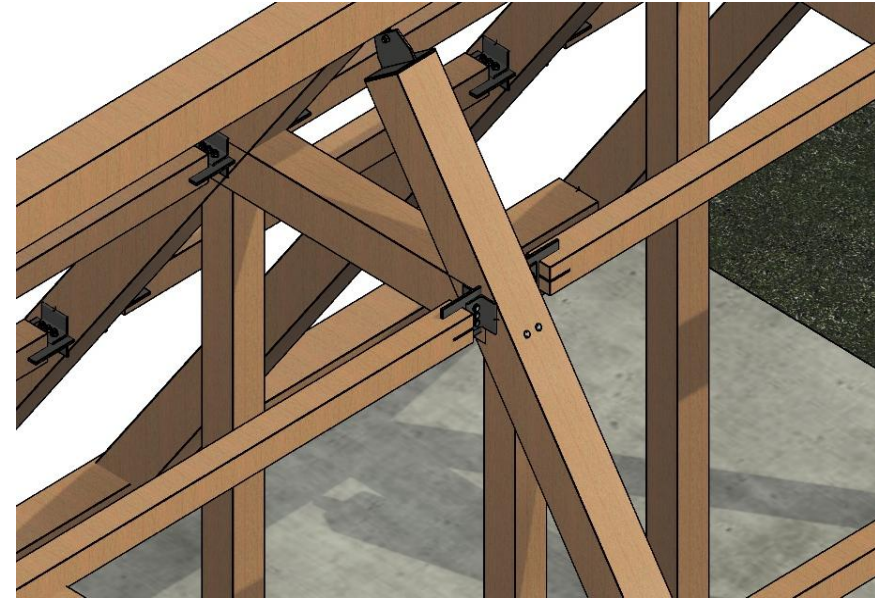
Sistema estructural en madera de fácil montaje uniones en acero.
